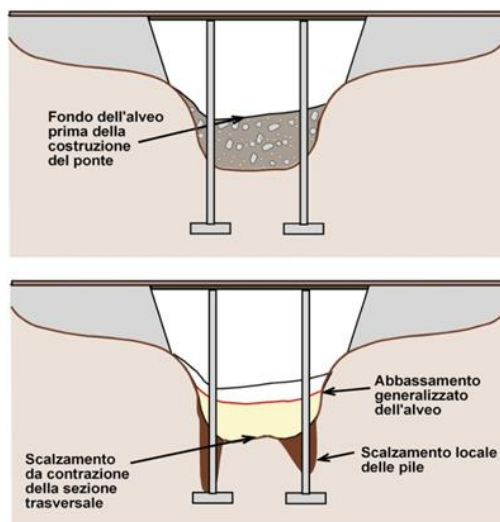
Componenti dello scalzamento nella sezione di un ponte generico
